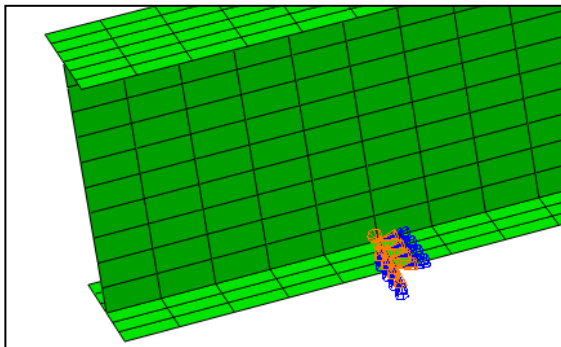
Modelação dos apoios da viga (apoio fixo)
